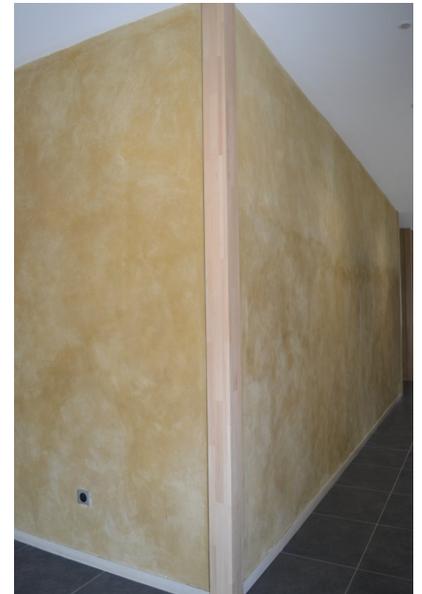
Aile est, premier étage, détail d'un mur couvert d'un enduit à la terre (après travaux).
